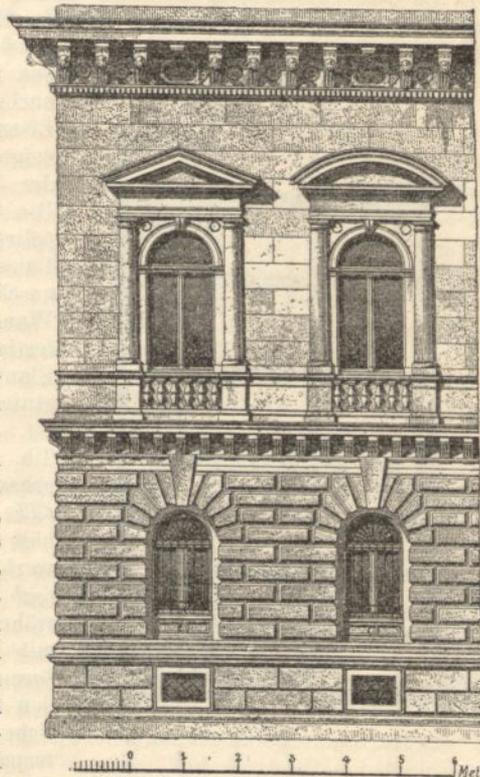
Façadensystem (Architekt Fr. Schachner).
